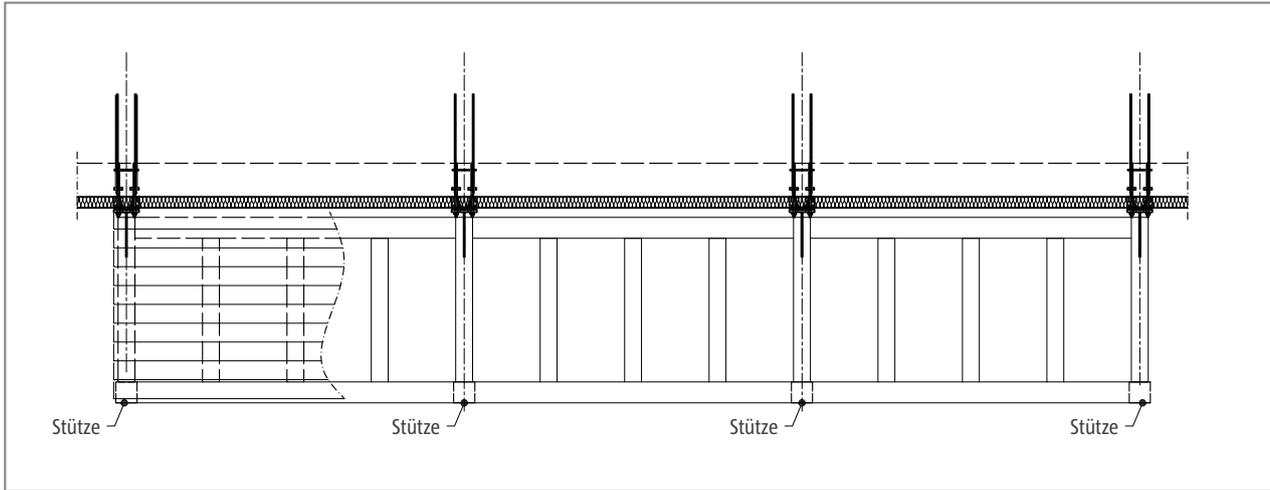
Schöck Isokorb® T Typ SQ mit Stahlschwert: Balkon gestützt
